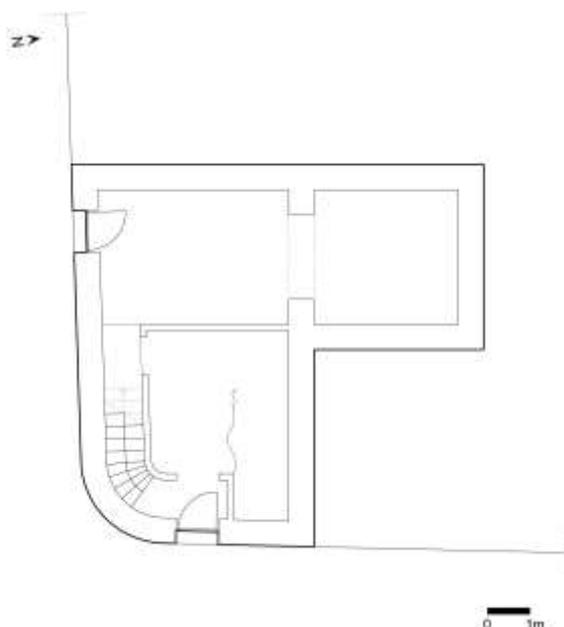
Planta do Piso 0 da casa L2, com divisão na loja e acesso interior ao piso de cima. (Ilustração nossa, 2021)
